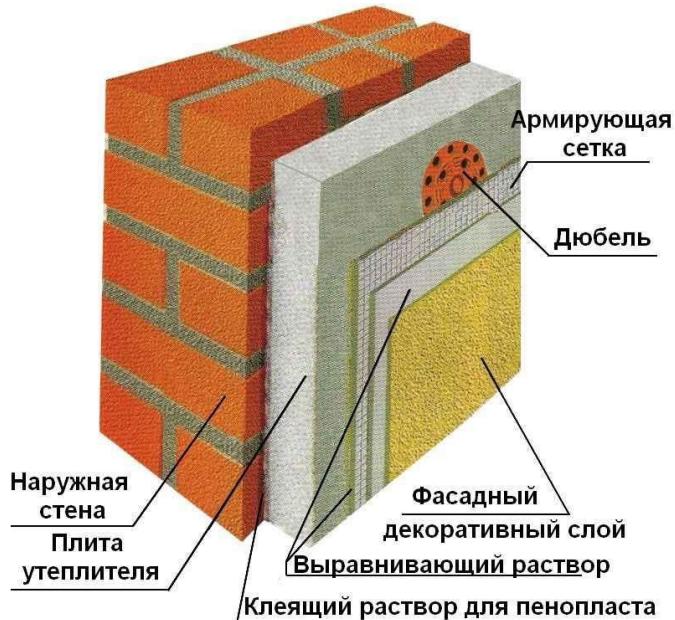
Общая схема утепления наружных стен пенополистиролом
